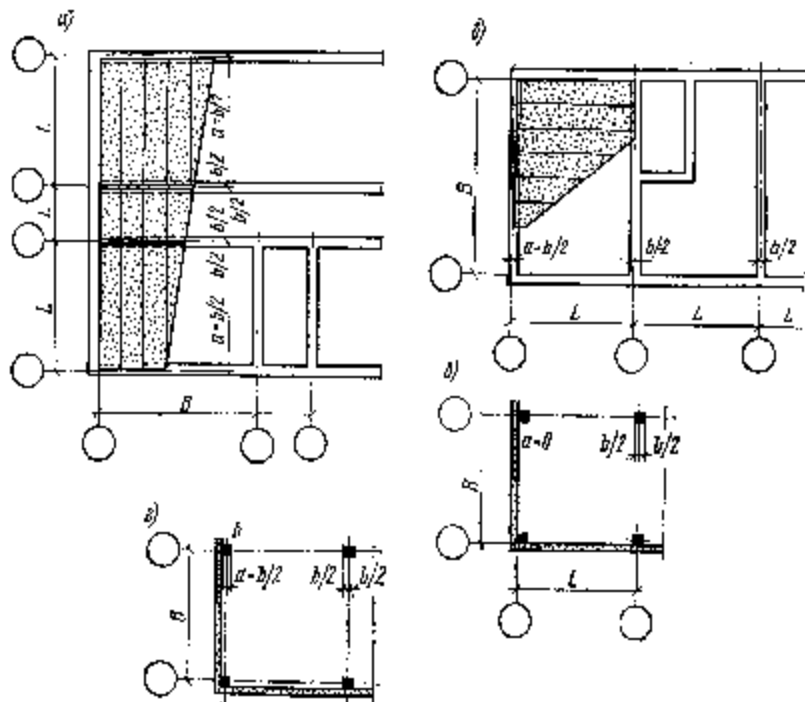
1. Примеры привязки стен к модульным разбивочным осям в плане здания: а - здание с продольными несущими стенами (привязка $b/2$), б – то же, с поперечными (привязка наружных продольных стен нулевая), в - крайний пролёт каркасного здания (привязка нулевая), г – то же, привязка $b/2$; L – пролёт, В – шаг.
